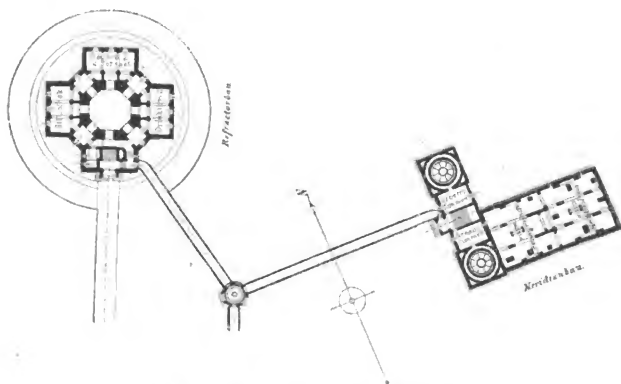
Grundriss der Strassburger Sternwarte.
